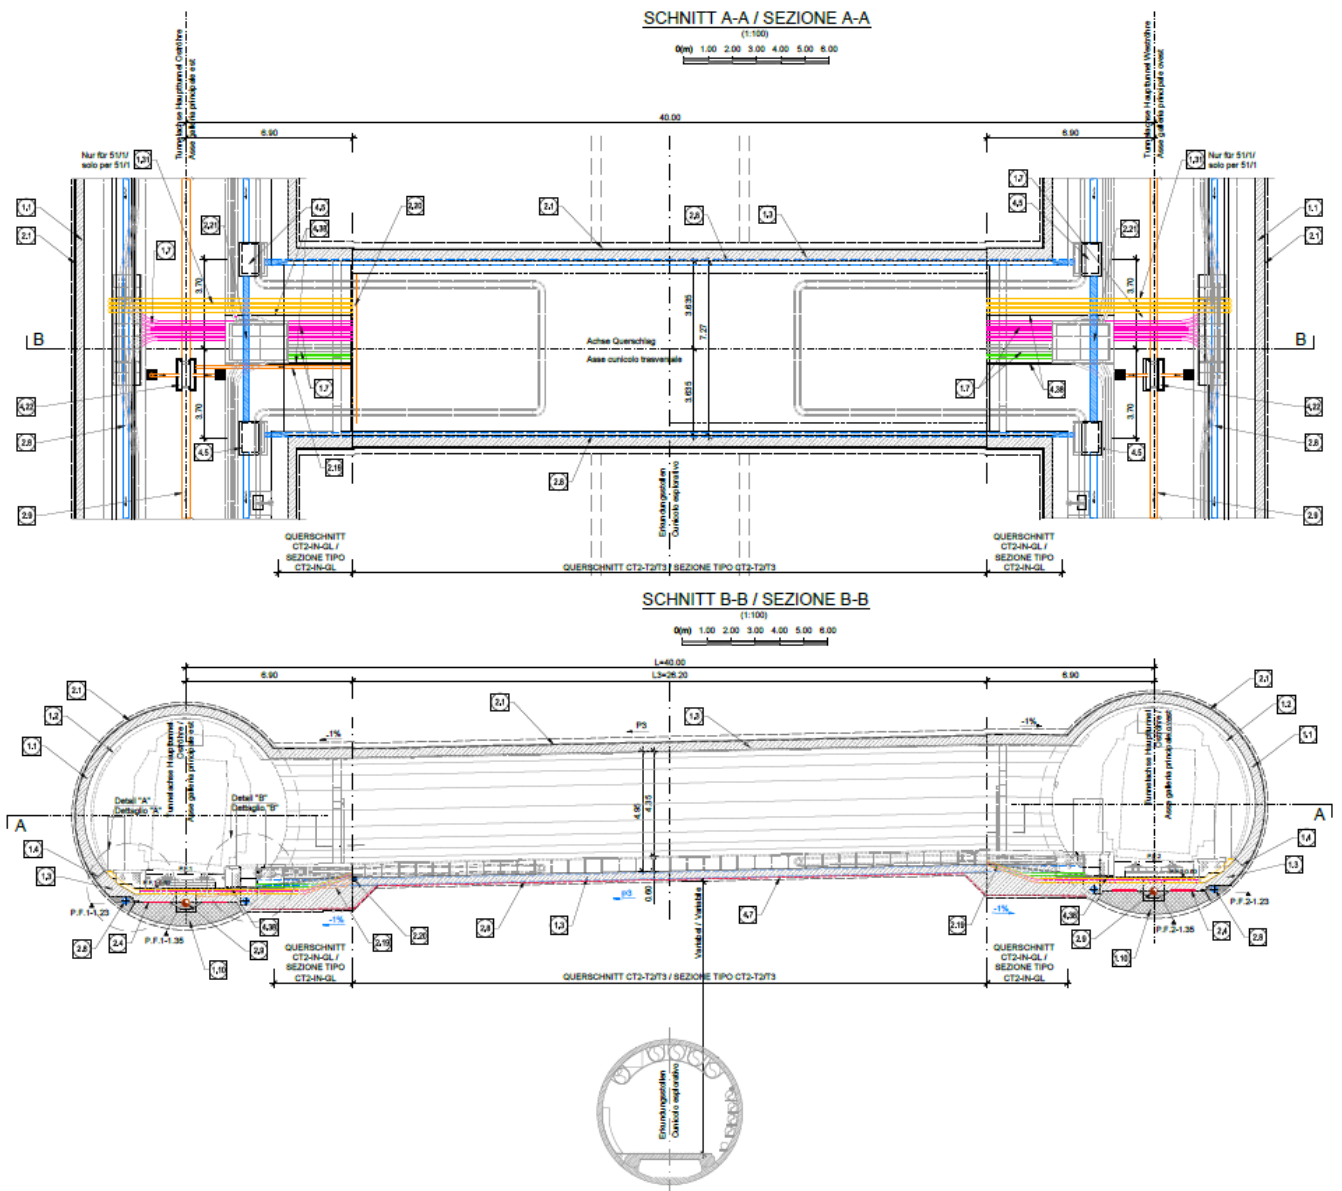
Querstellen Typ 2 - Grundriss und Längsschnitt [94].
